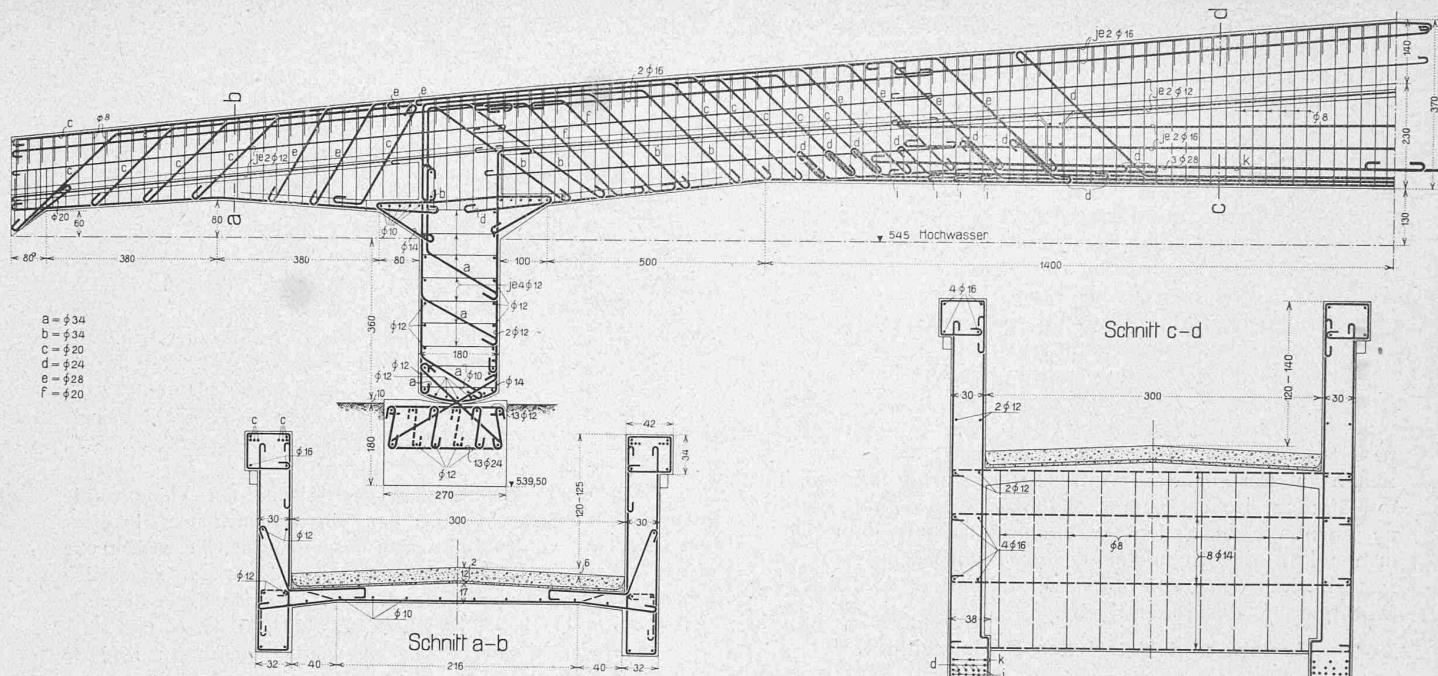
Armierungsplan der Waldeckbrücke bei Burgdorf. — Ansicht etwa 1:150, Schnitte 1:60.
